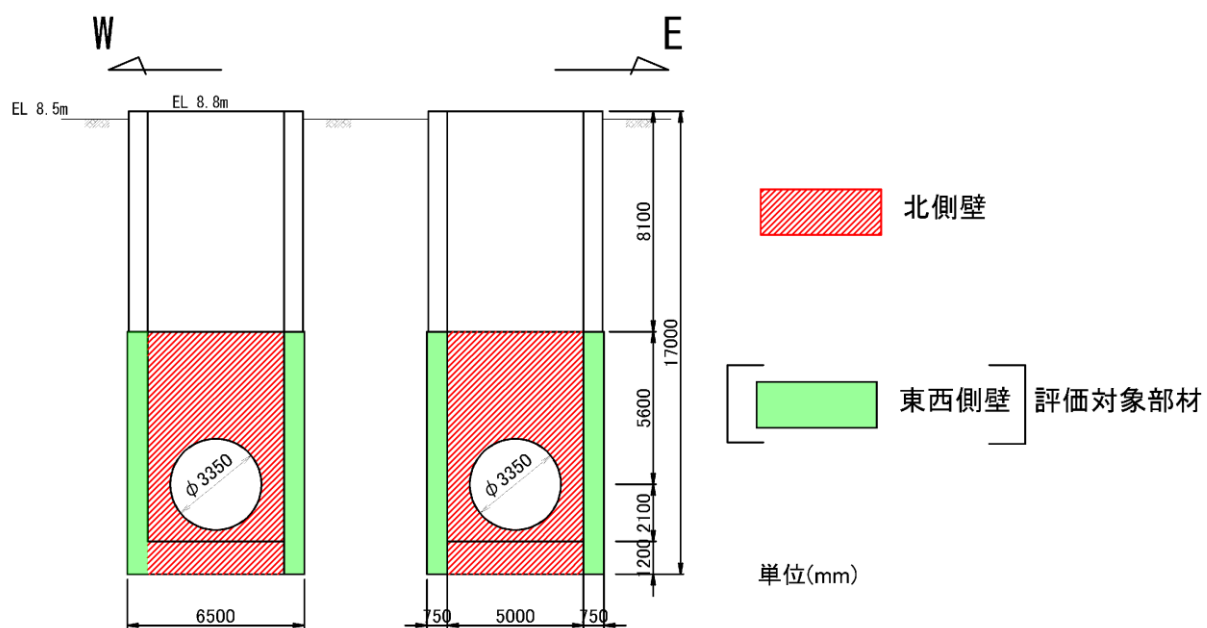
1号機取水槽評価対象部材断面図 (B-B断面)
